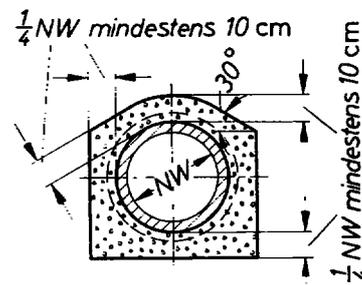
Ausführungsbeispiel einer vollen Ummantelung mit Beton
